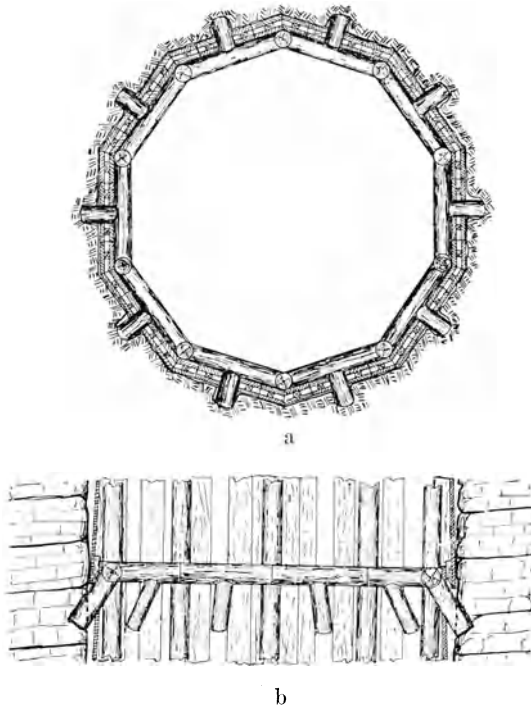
Jochkranz mit Strebebolzen. a) Grundriß, b) Aufriß.
